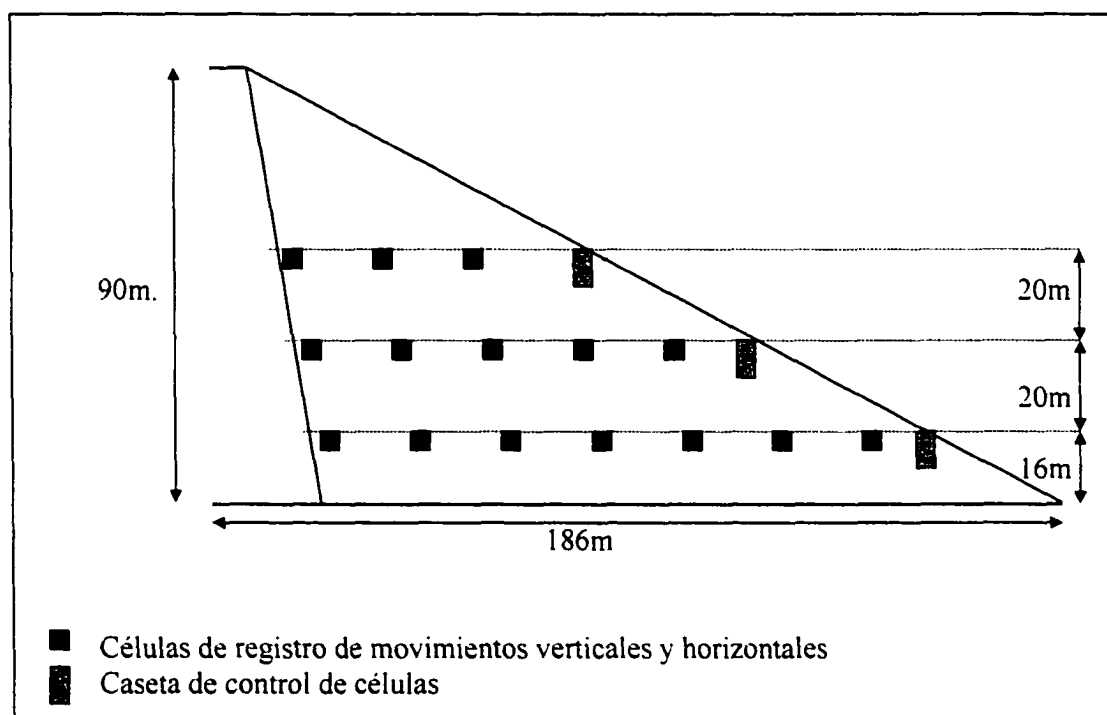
Geometría y esquema de instrumentación de la Presa de Llyn Brian
